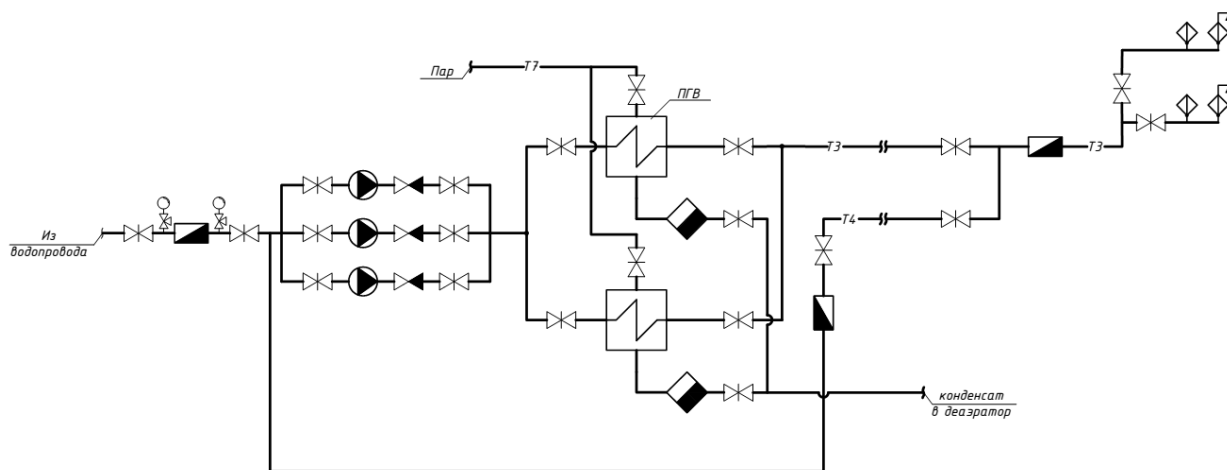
б – Схема водоподогревательной установки с циркуляционными насосами
